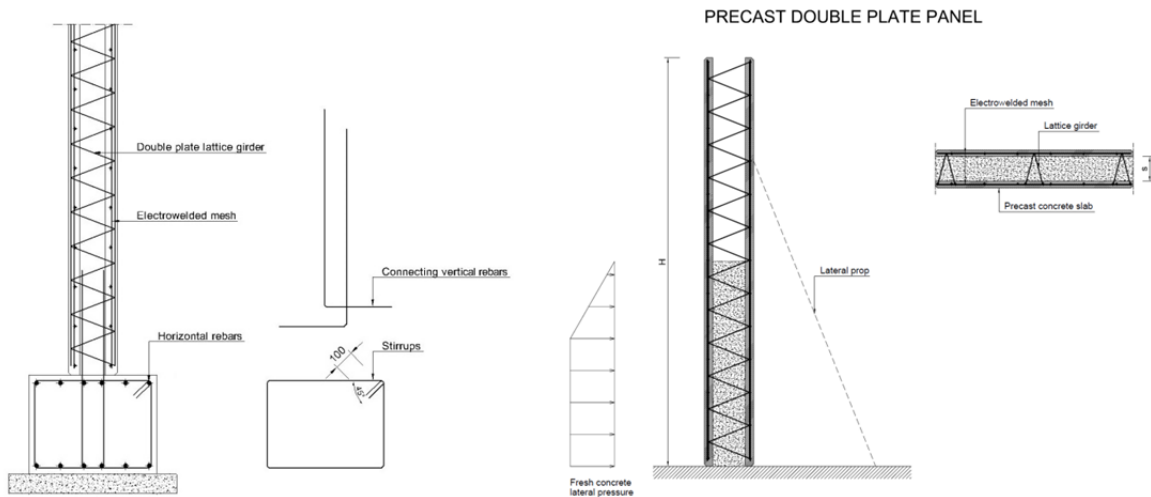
Particolare connessione tra parete e fondazione (sezione verticale).
